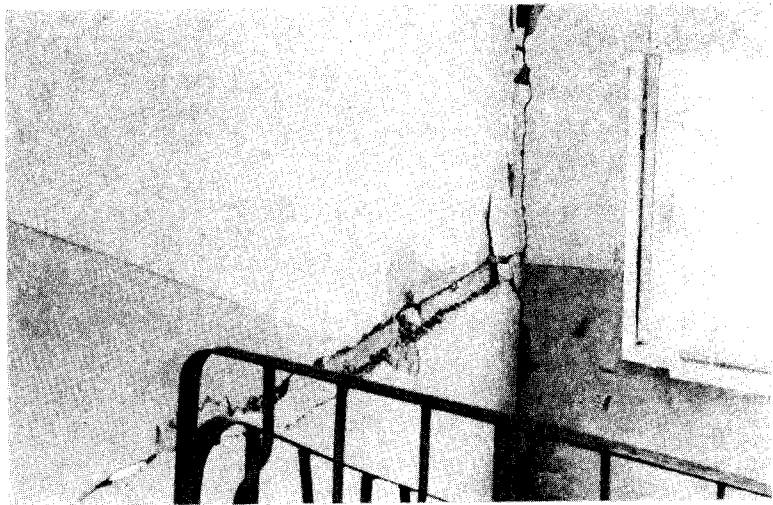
21. Повреждение горизонтального стыка стен лестничной клетки четырехэтажного дома
